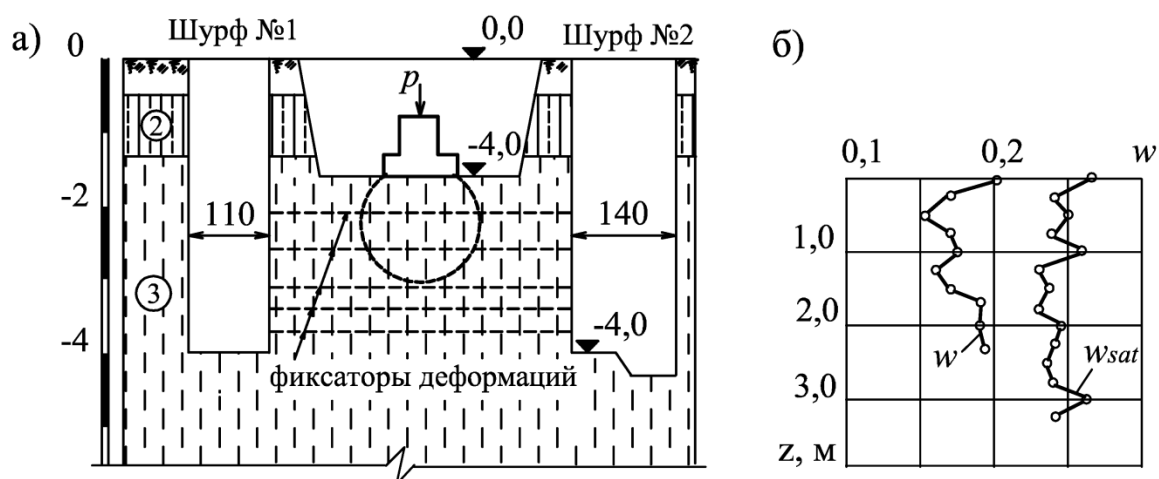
Схема испытаний грунта опытным фундаментом №1: а) геологическое строение участка; б) влажность грунта
